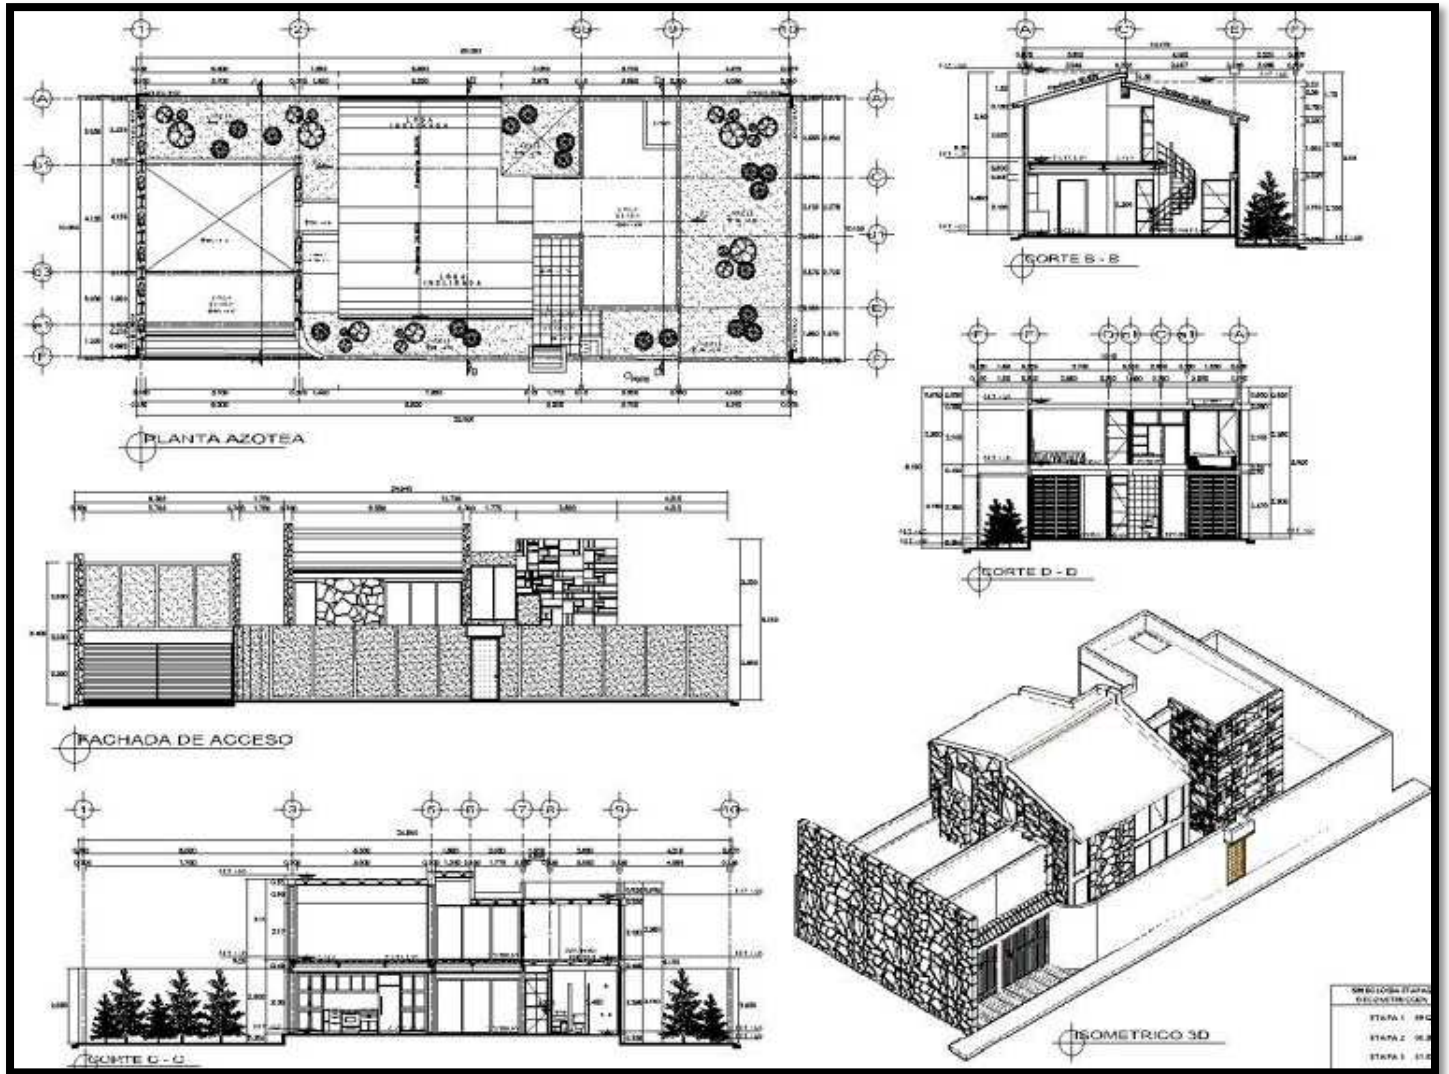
Ejemplo de un plano arquitectónico con cortes. Fuente: (Imágenes Google. 2017).
